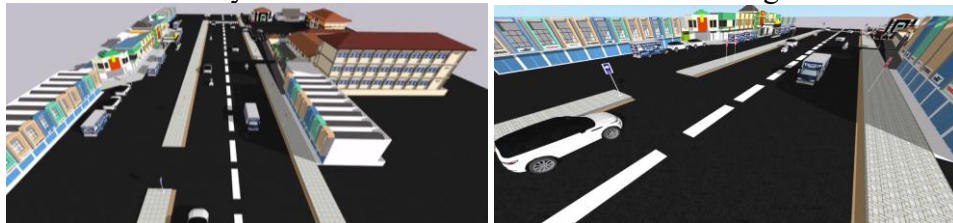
Layout Usulan Pengadaan dan Pemasangan Rambu
